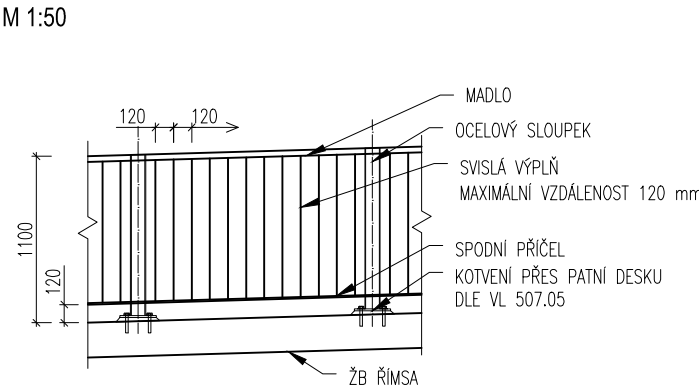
DETAIL ZÁBRADLÍ NA OPĚRNÉ STĚNĚ
